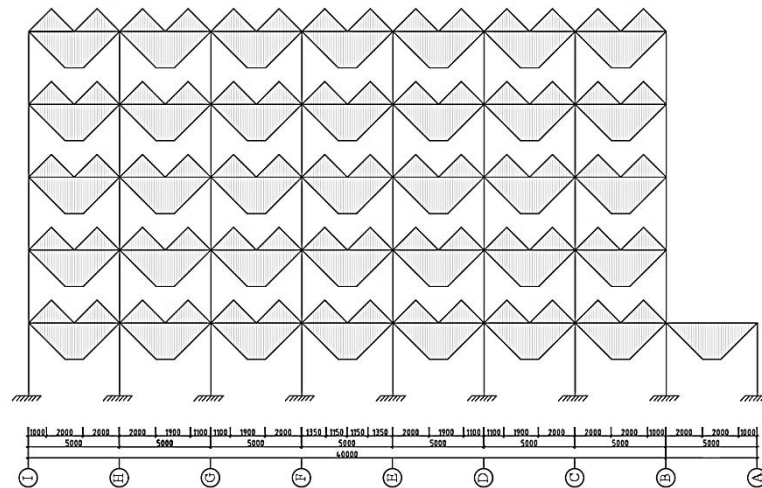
Denah Potongan Portal As C dan Portal As 3 Lantai 4
